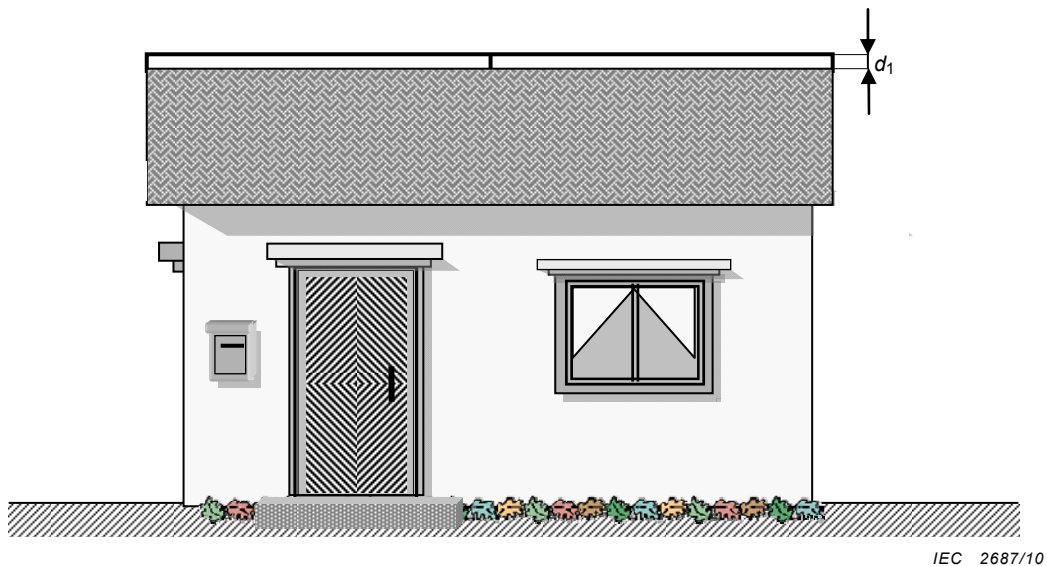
Projection sur un plan vertical contenant le conducteur
